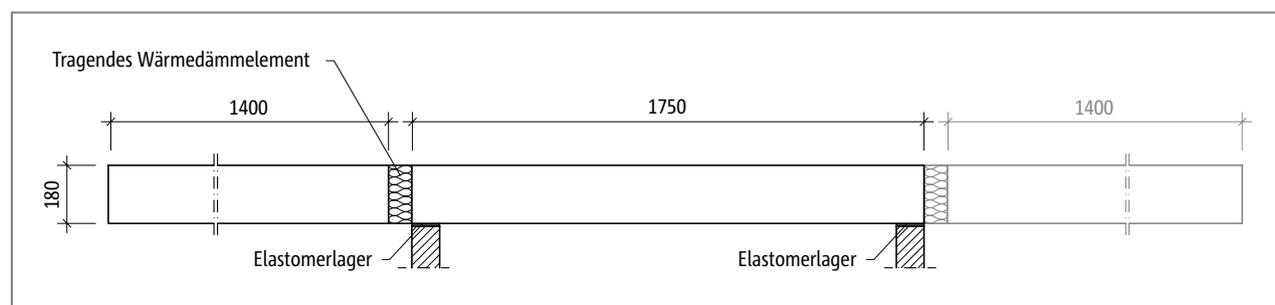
Prüfaufbau nach EAD für tragende Wärmedämmelemente, Schnitt
